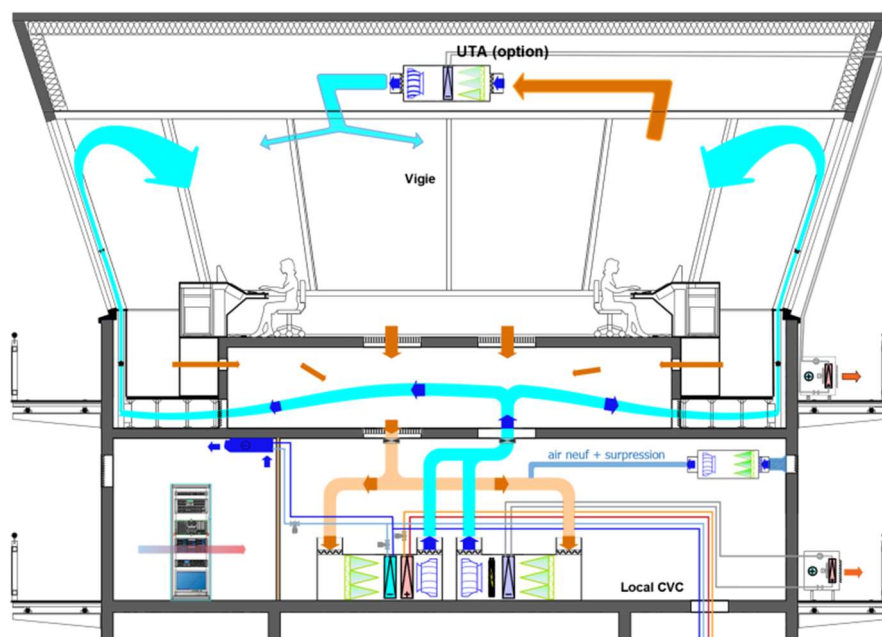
Coupe de principe Vigie – 2 CTA EG/DD et EC – appoint / secours ultime en plafond
